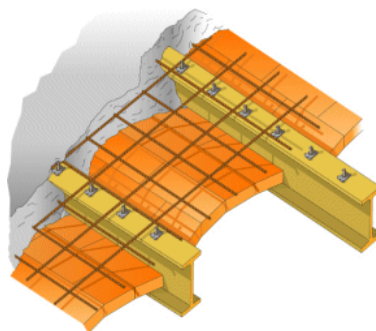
detalle de conectores sobre viga metálica para solidarizar la estructura mixta.
